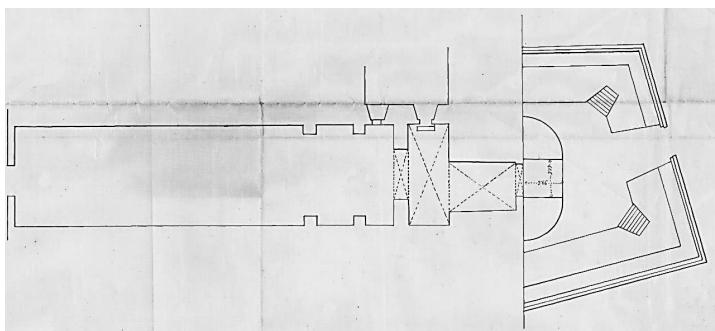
Planta de la Puerta de la Colada con su fosete, puente levadizo y barbacana en 1881. AGMM.
